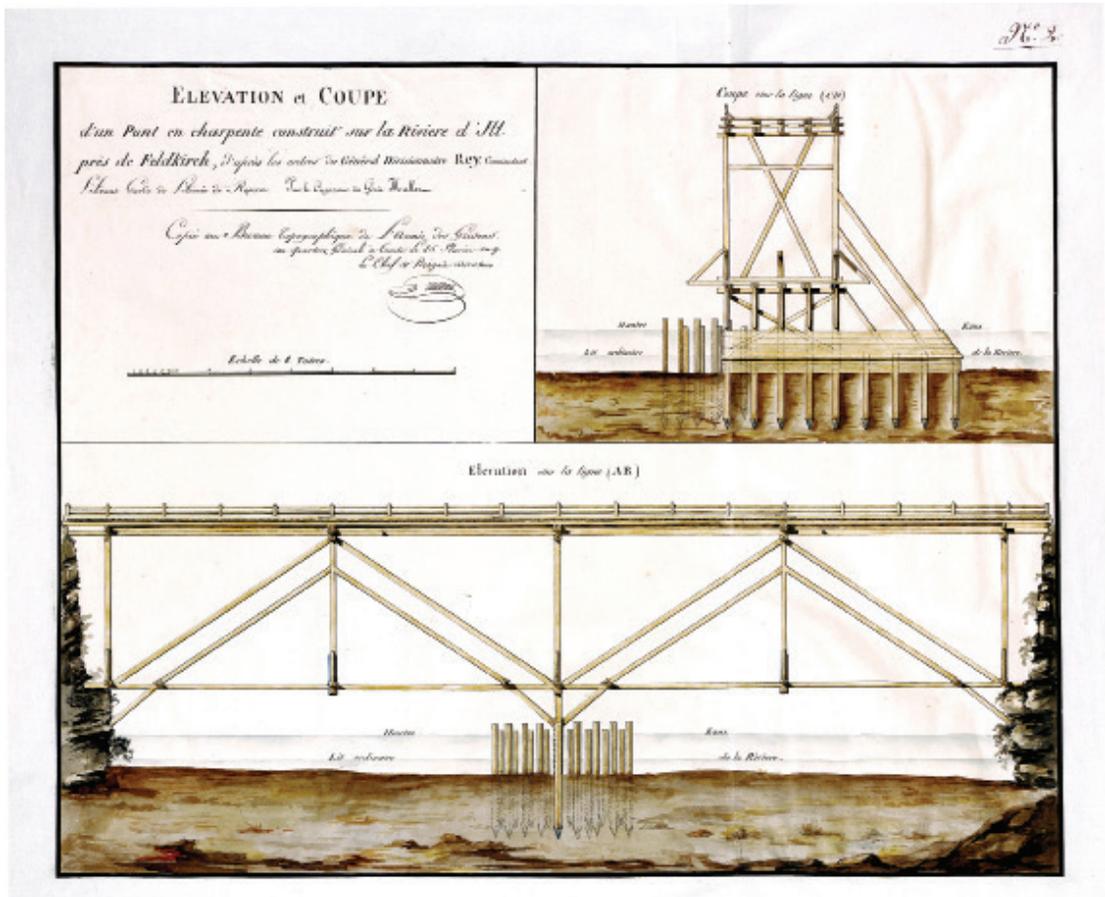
Elevation et Coupe d'un pont en charpente construit sur la Riviere d'Ill près de Feldkirch, d'après les ordres du Général Divisionnaire Rey, Commandant l'Avant Garde de l'Armée de Reserve* (560x455 mm)
